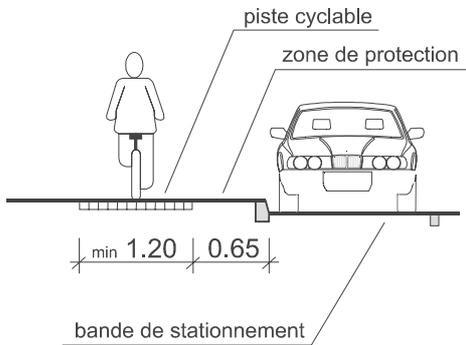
piste cyclable unidirectionnelle stationnement longitudinal
